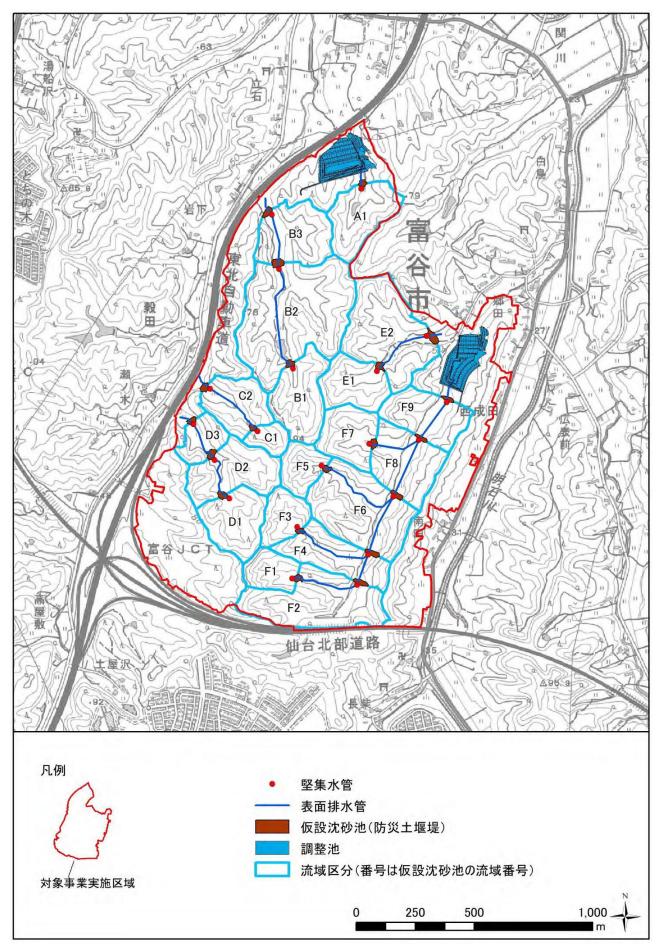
防災計画平面図 (仮設沈砂池 (防災土堰堤) 、表面排水管等)
